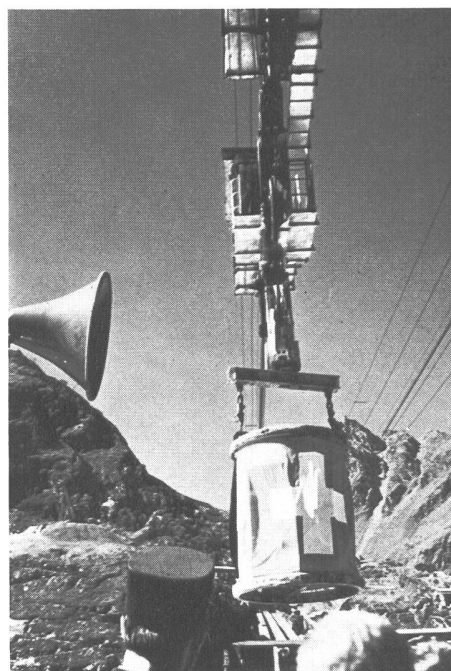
Der flaggengeschmückte Betonkübel bringt den letzten Beton
